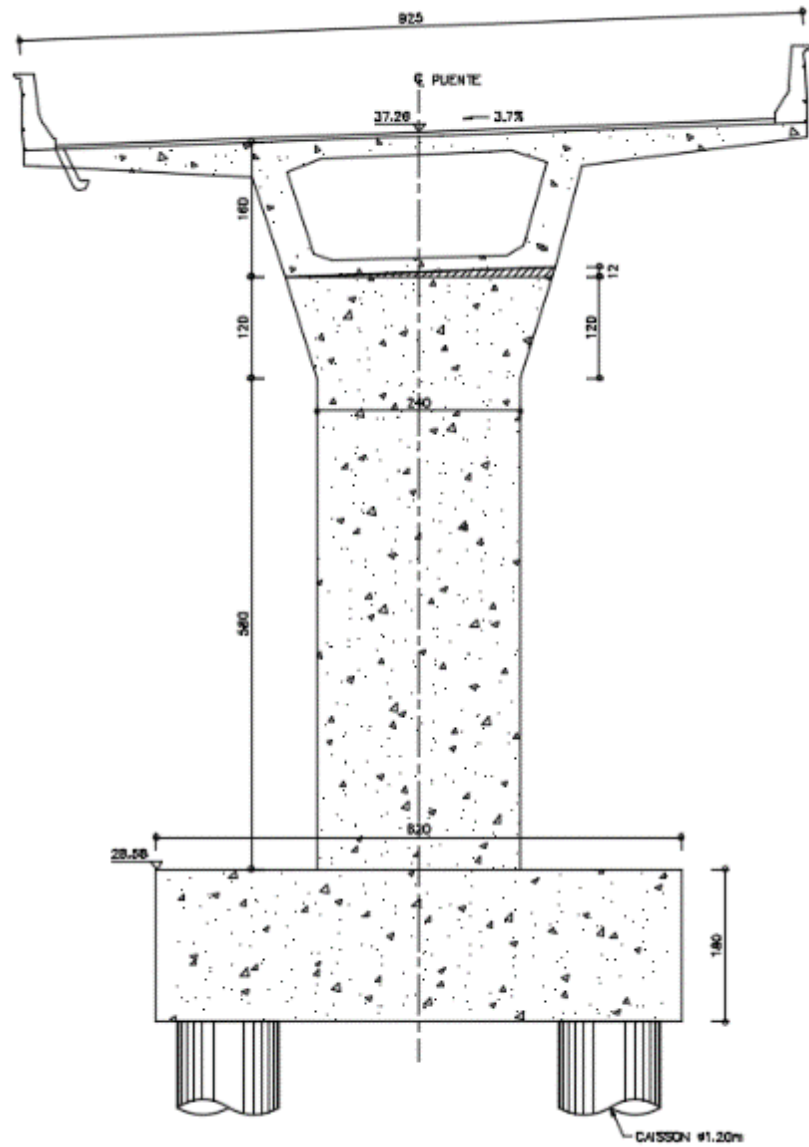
Geometría apoyo eje 3 – Puente Vía a Minca
